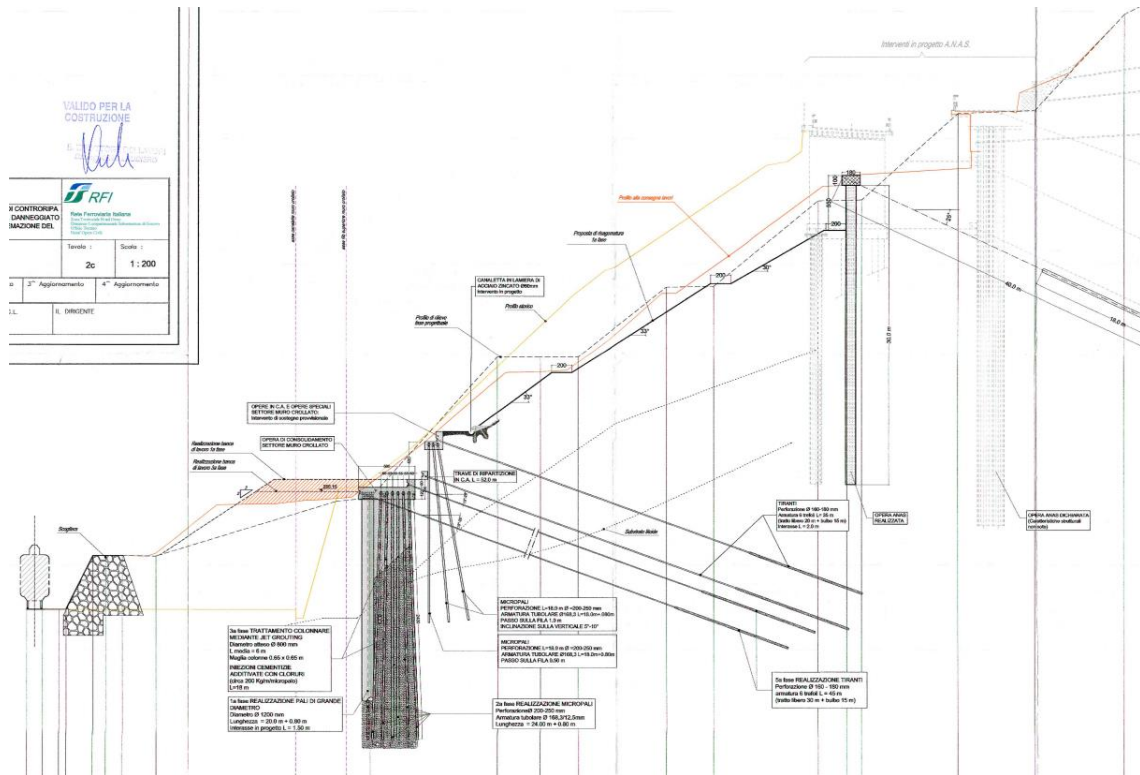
Stralcio di una delle sezioni di progetto 2003 per il tratto di muro crollato.
